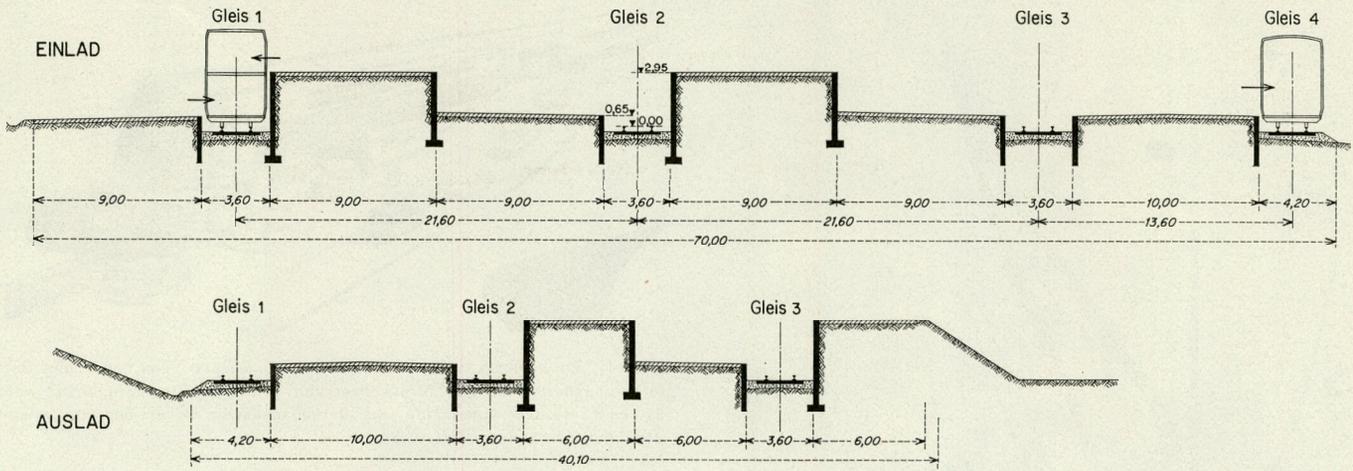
Querschnitt der Einlade- und Ausladerampen, Massstab 1:400
